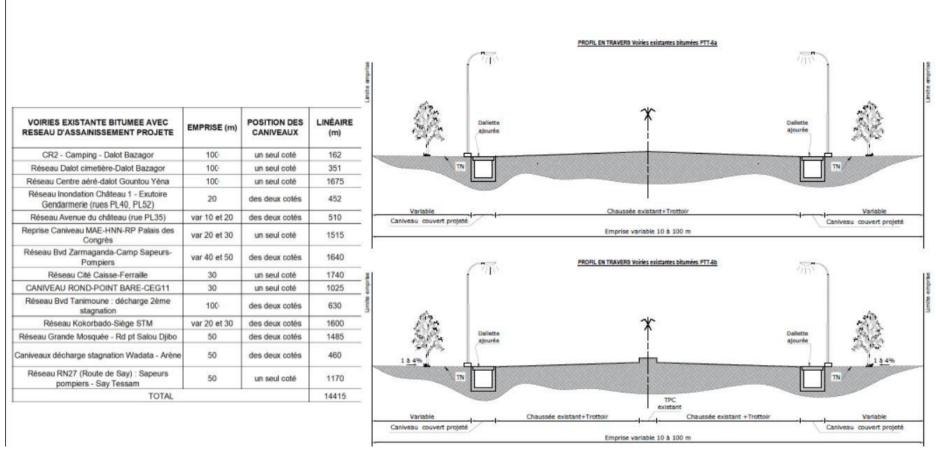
Profil en travers type 5 – Voiries existantes bitumées (PTT-5)
